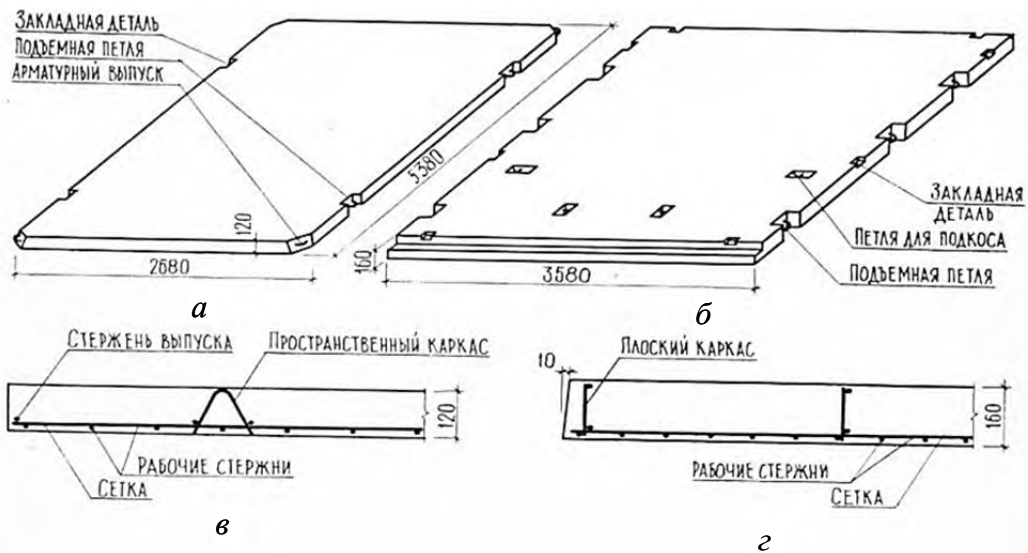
Сплошные железобетонные плиты перекрытий крупнопанельных зданий:
